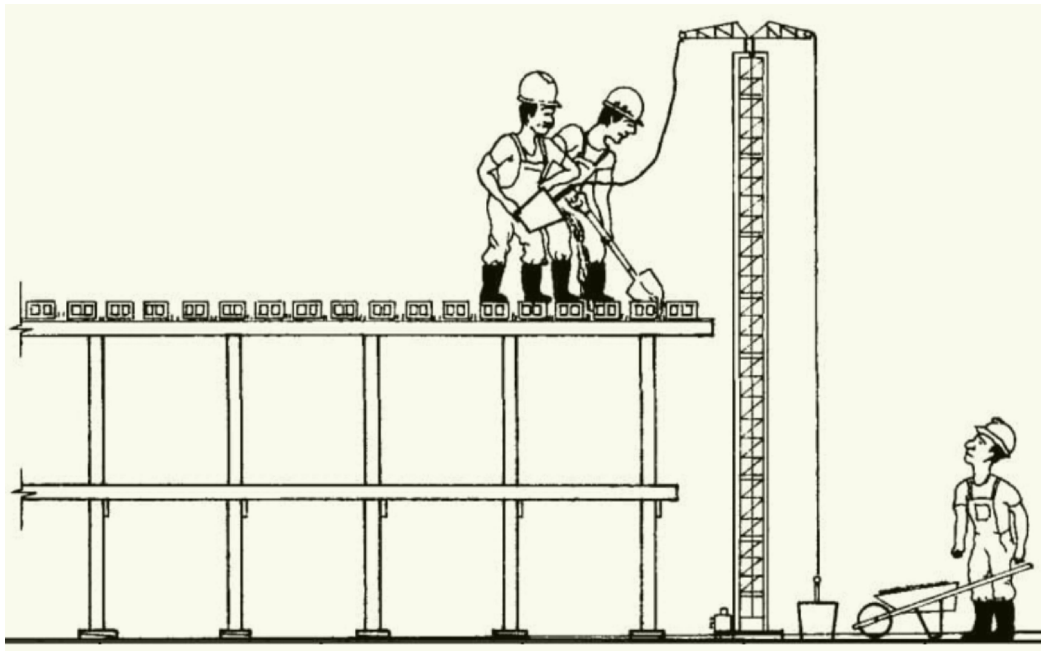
Mano de obras para elaborar hormigón simple colocado en losa de entrepiso
